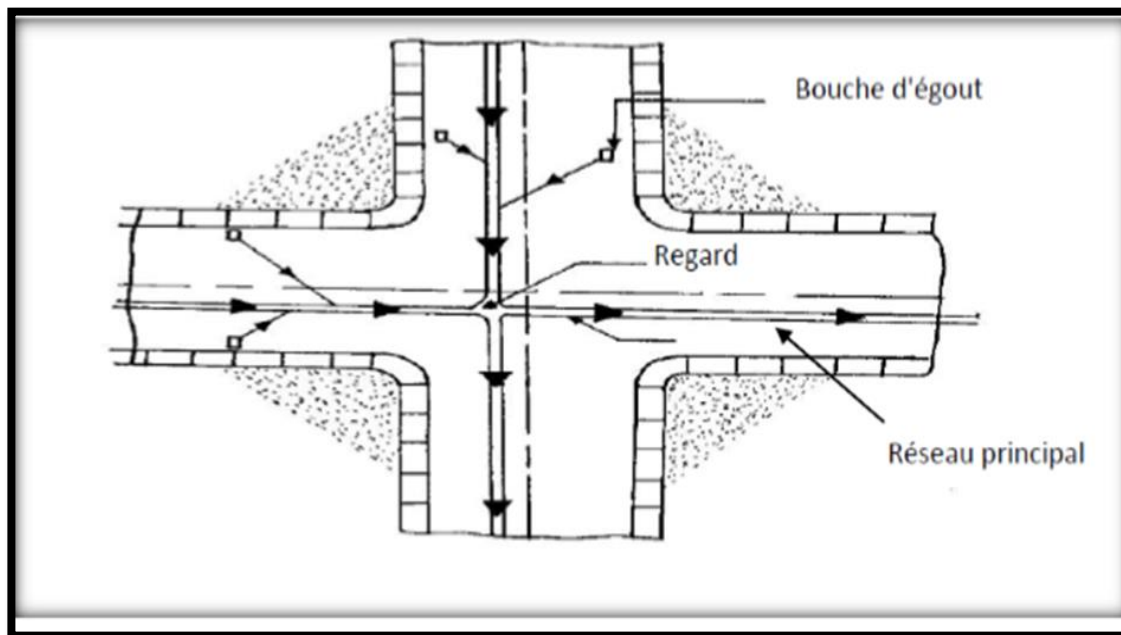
Schéma représente emplacement des bouches d'égout
